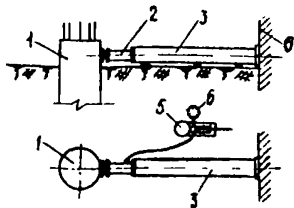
Схема испытания на горизонтальную нагрузку одной свай:
